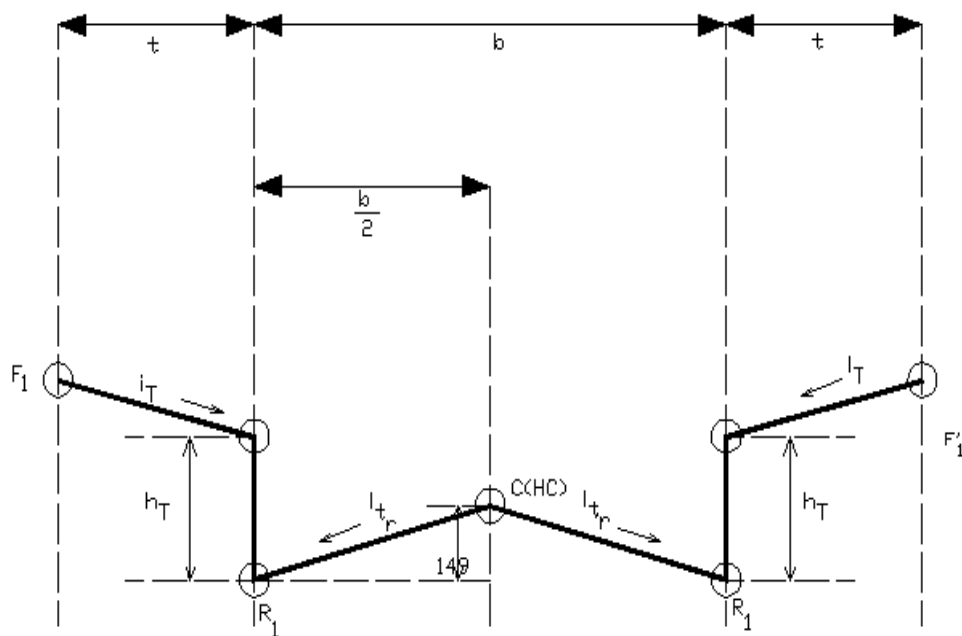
Profilul transversal cu elementele sistematizării verticale
